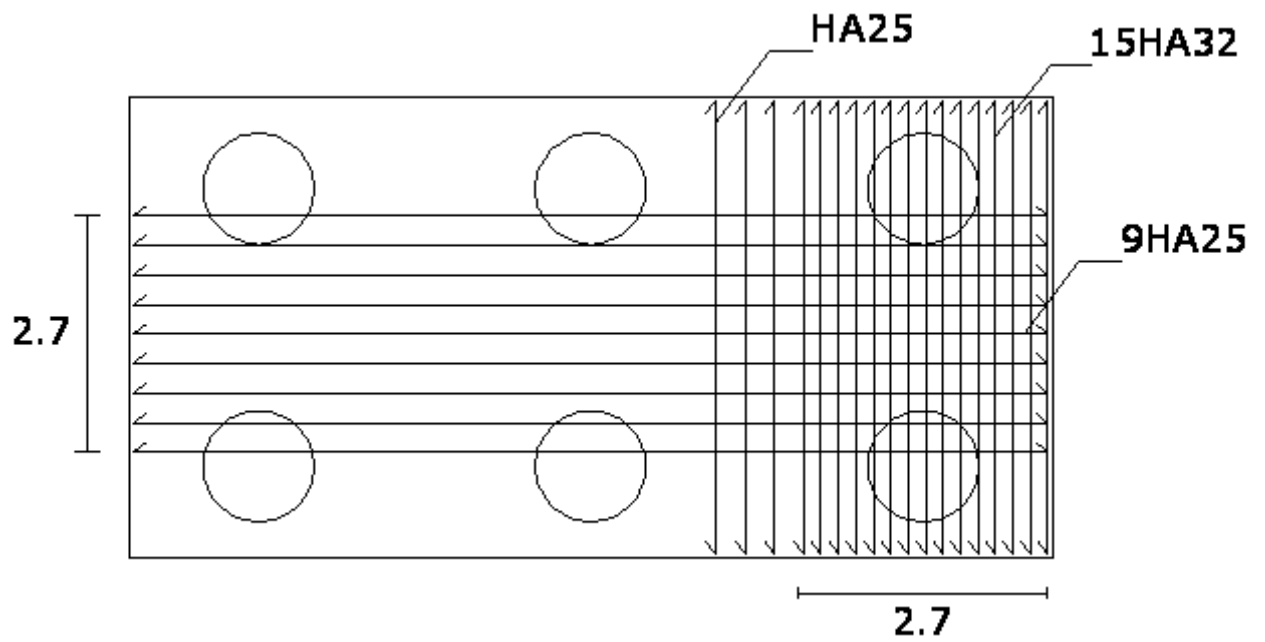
Ferrailage de la semelle en plan (nappe supérieure)
